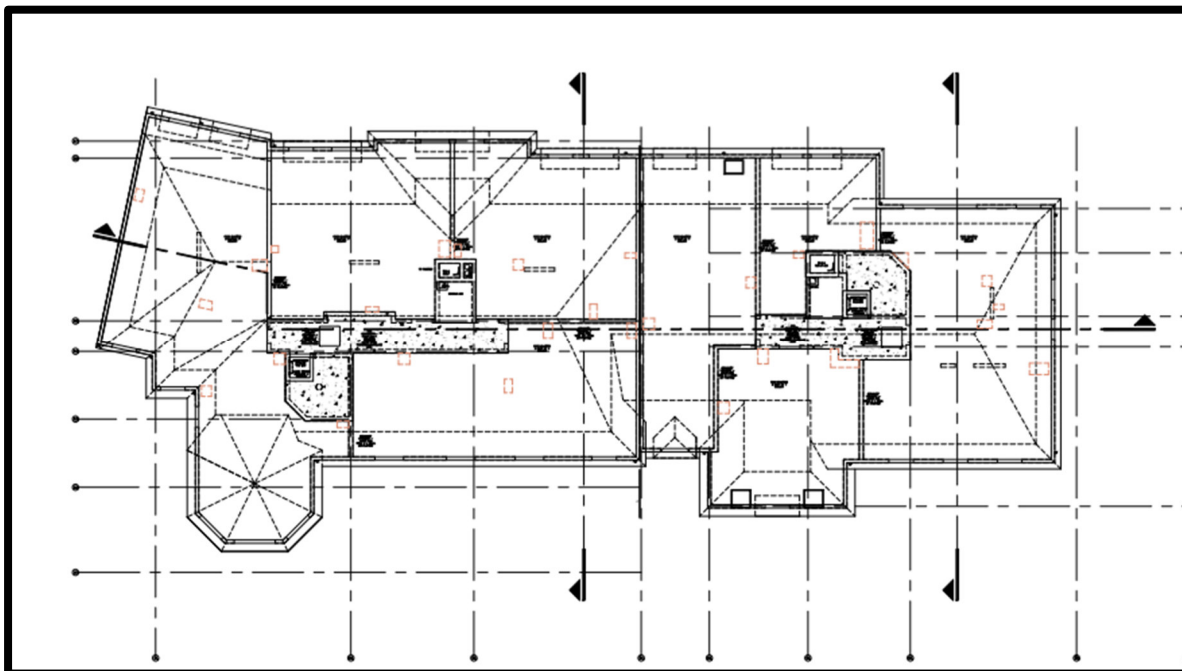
Planta Cobertura do edifício de estudo (fase projeto)
